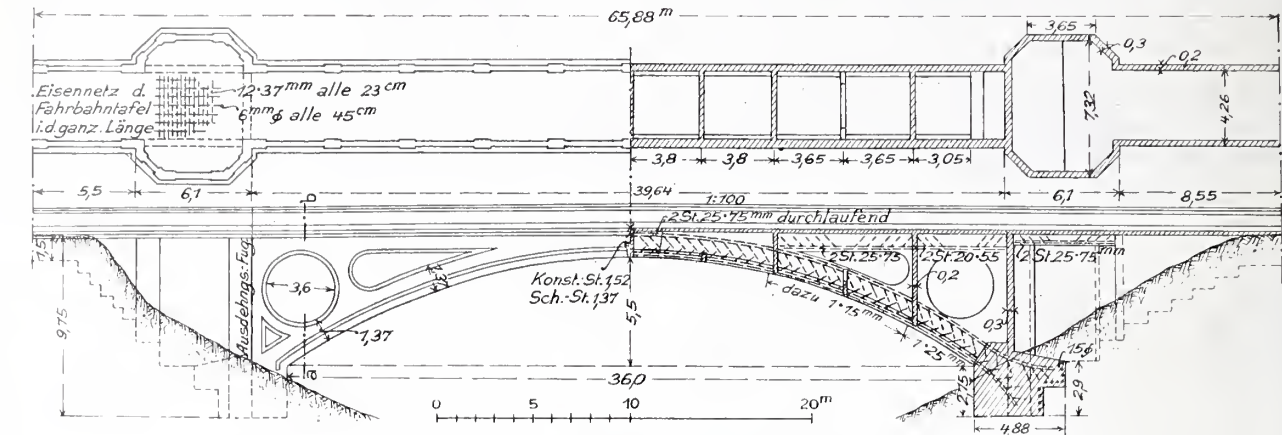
Aufsicht und Grundriß; Ansicht und Längsschnitt.
